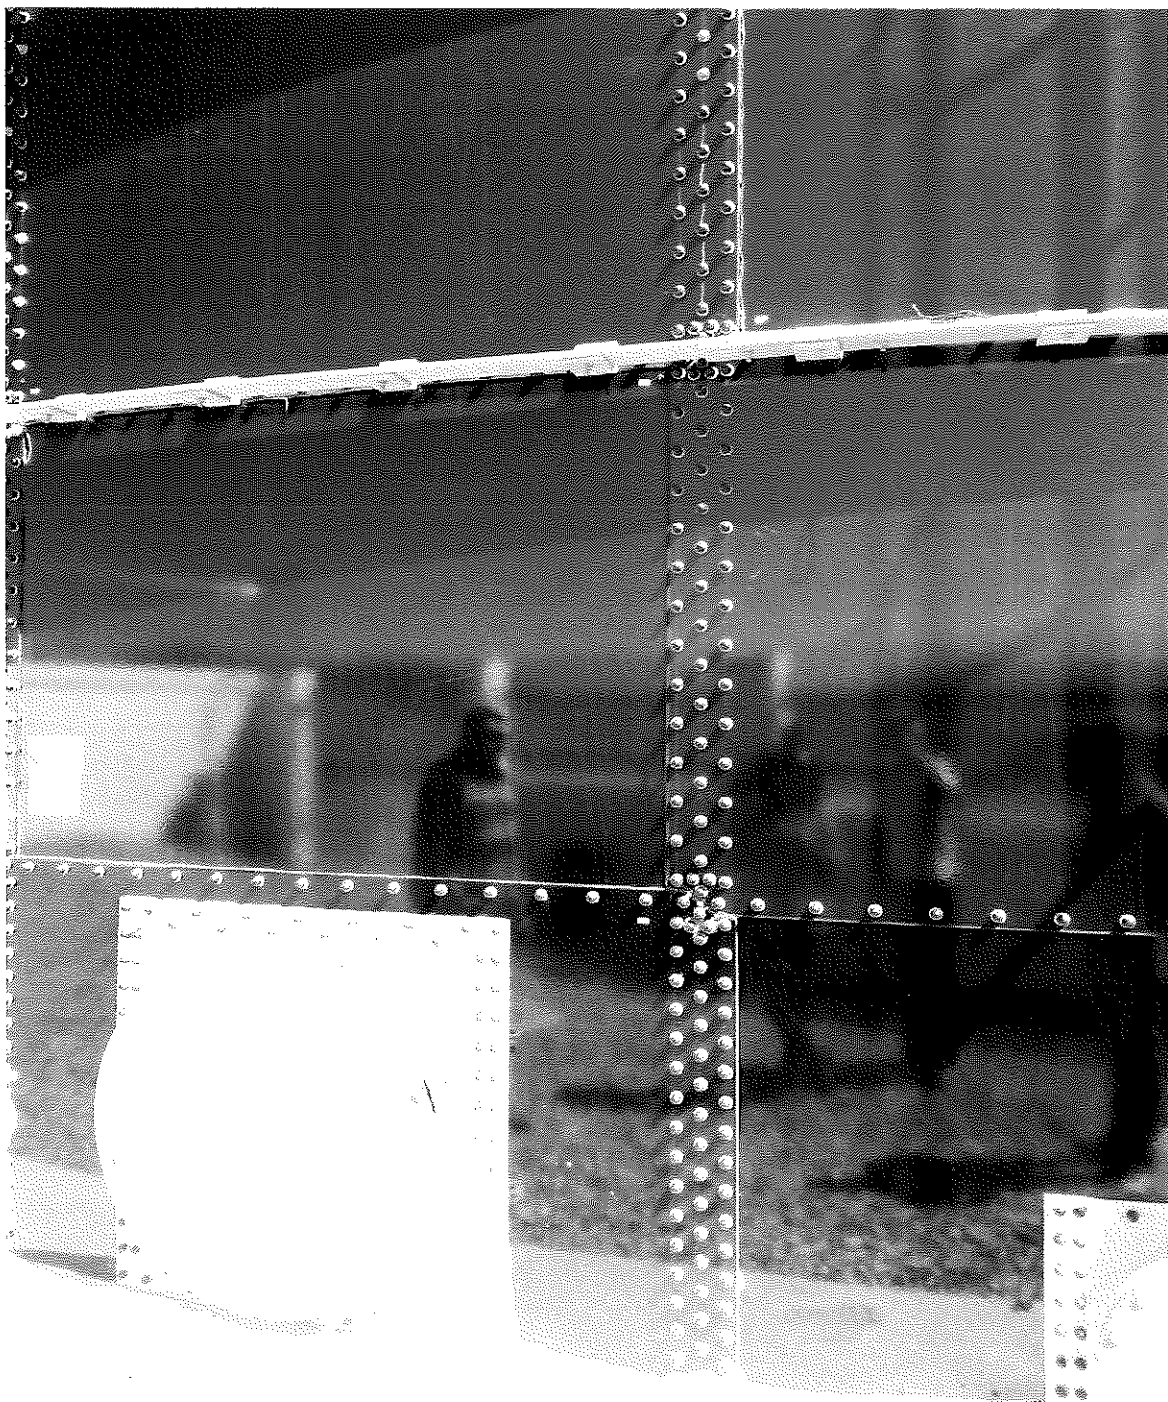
Detalle de colocación de láminas, atiesadores planos y entrada hombre.
